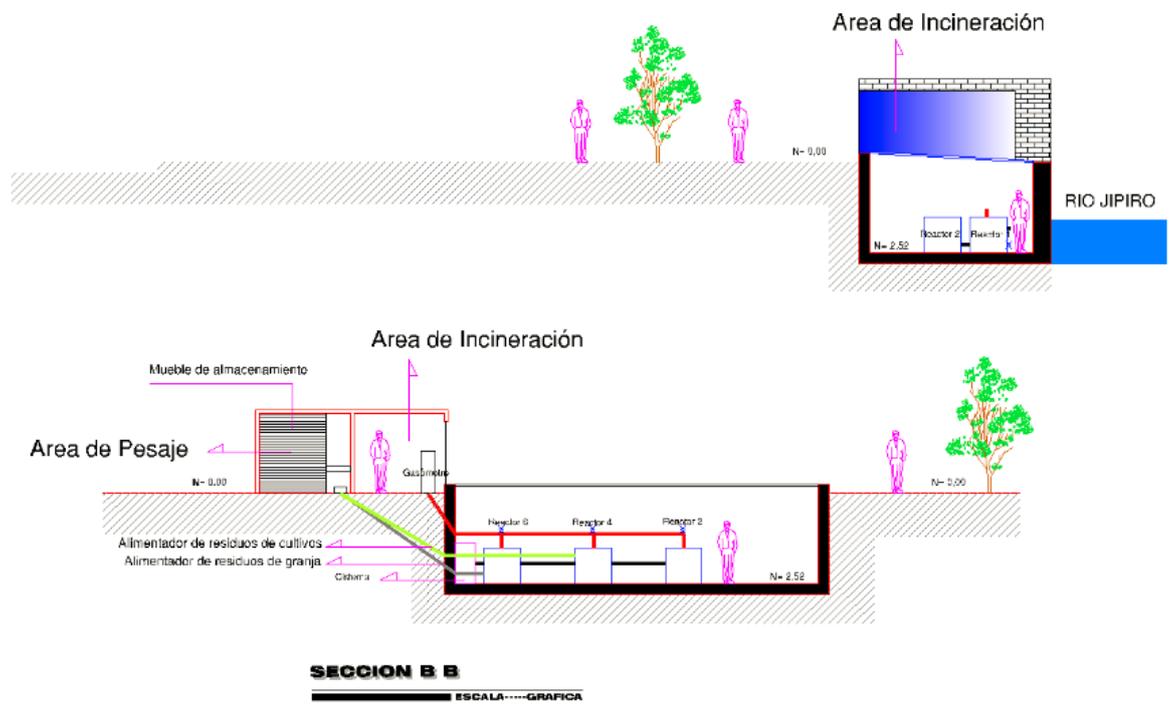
Detalles de la obra civil propuesta para el emplazamiento del sistema de biodigestores en el PRJ.
